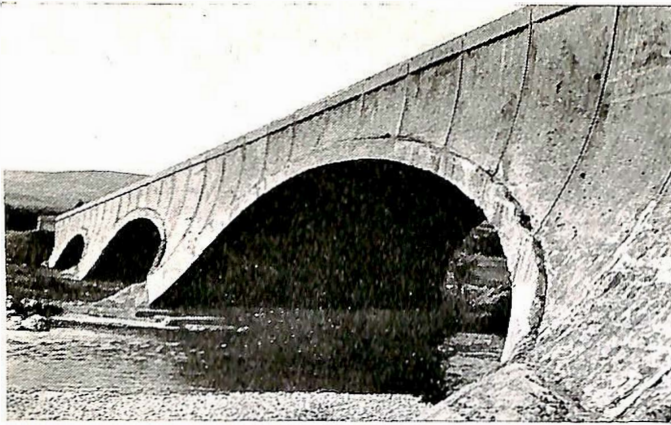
Spey bridge nær Kingussie. Merk den elendige betong, sterk forvitret.
